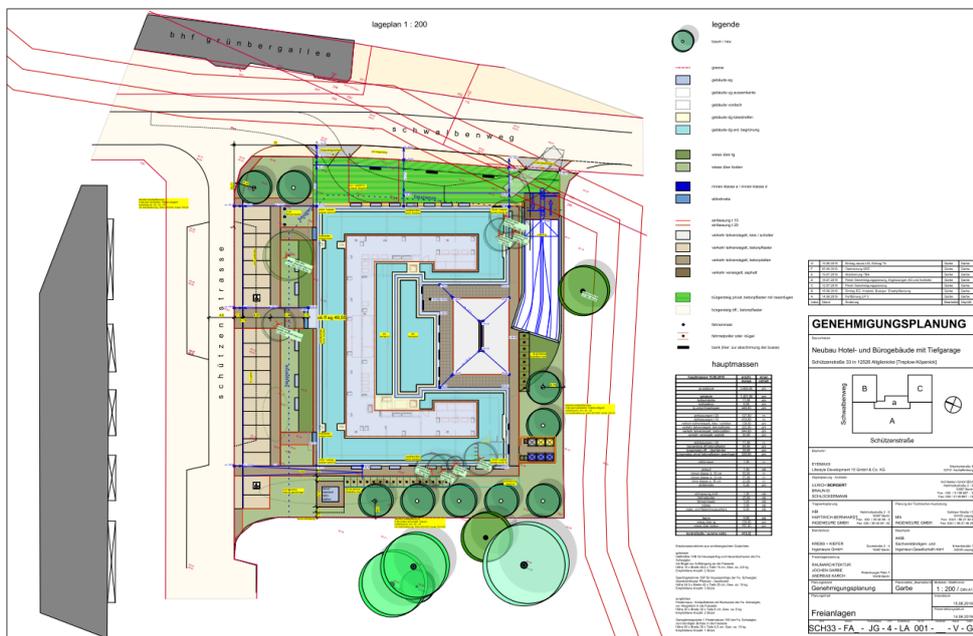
Lageplan Neubauvorhaben (aus [1])
